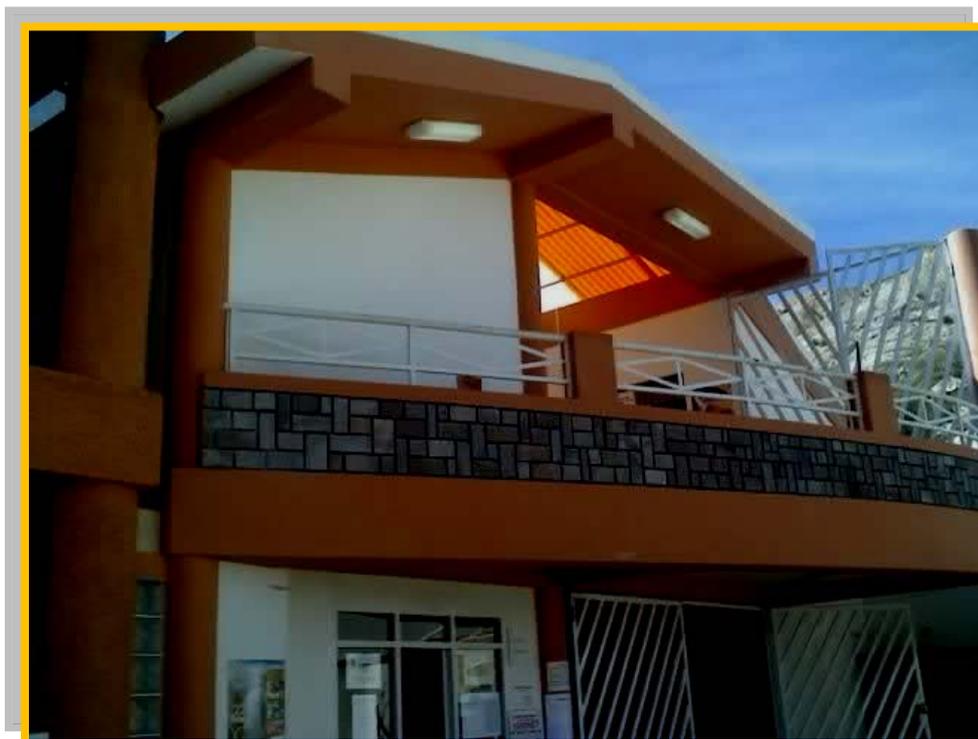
Collage de piedra laja en la fachada del mercado municipal de Torata.
